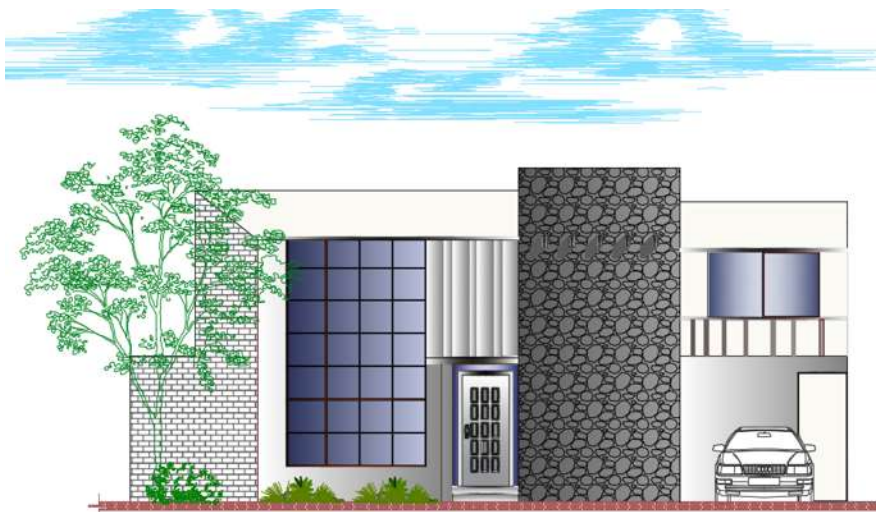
Fachada del segundo nivel con 258 m² de construcción
